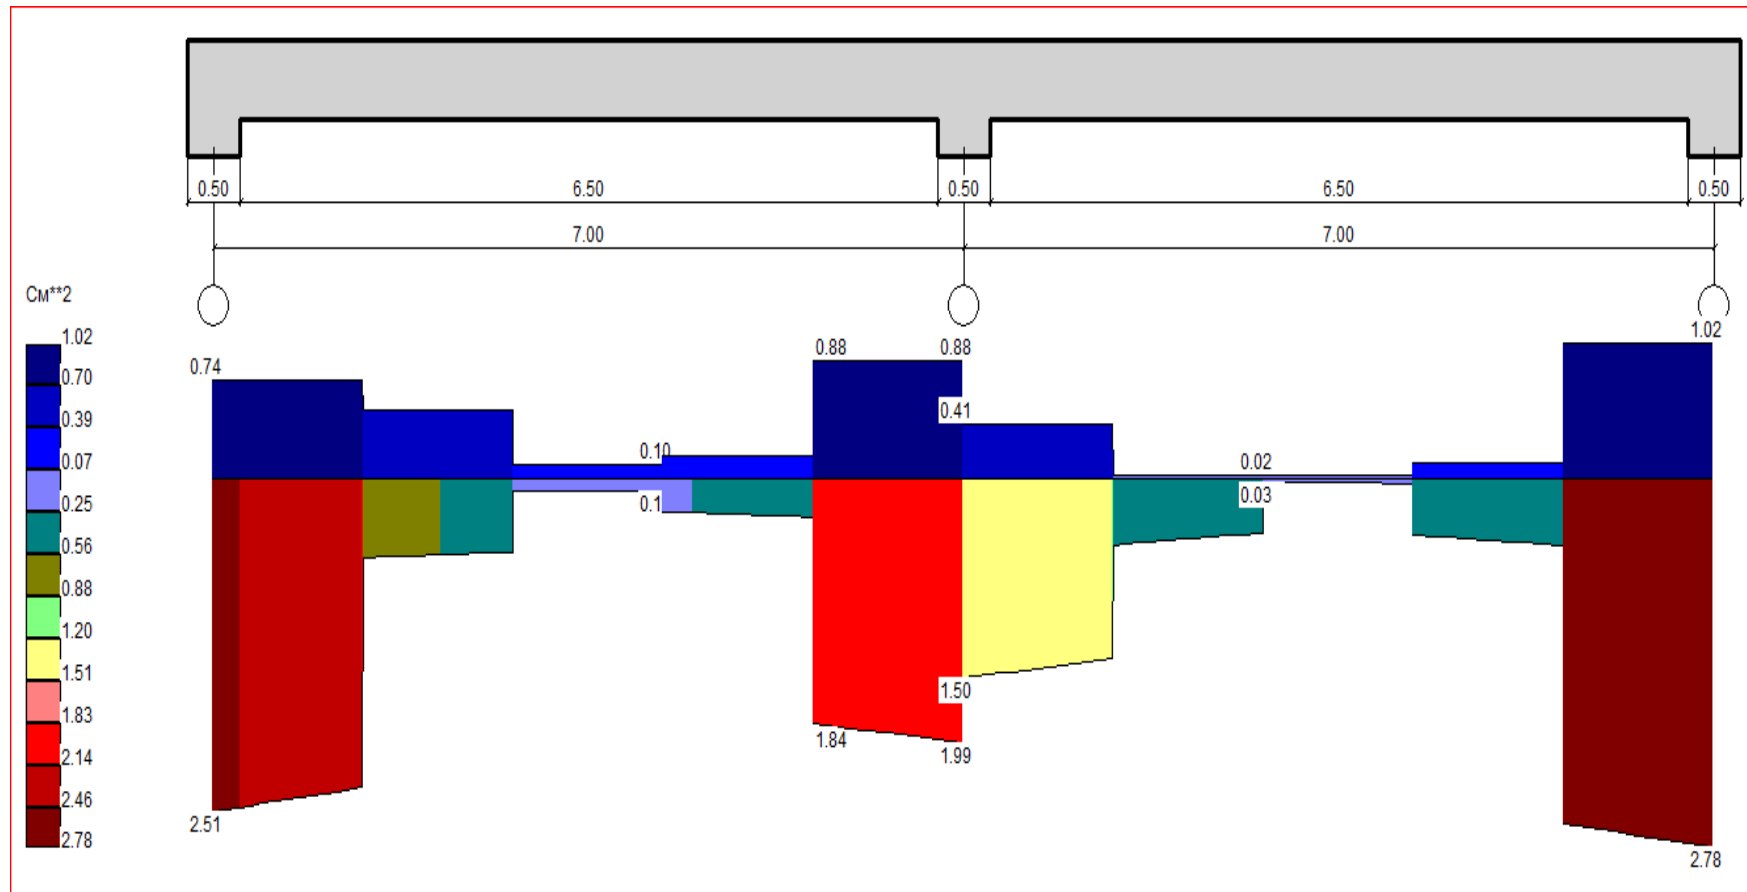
Варіант балково-плитного перекриття. Балка 1-9. Епюра розрахункового поперечного армування
